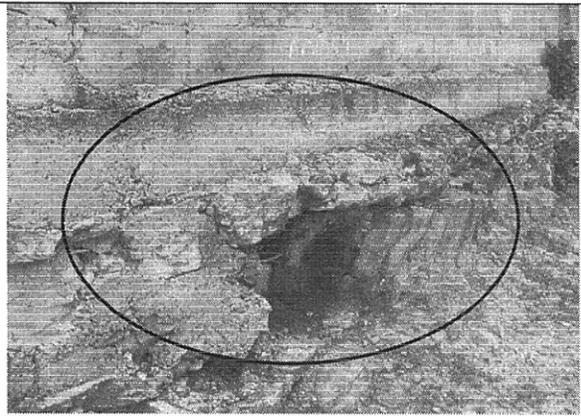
Pérdida de suelo de cimentación en la zona central del muro de cerramiento
